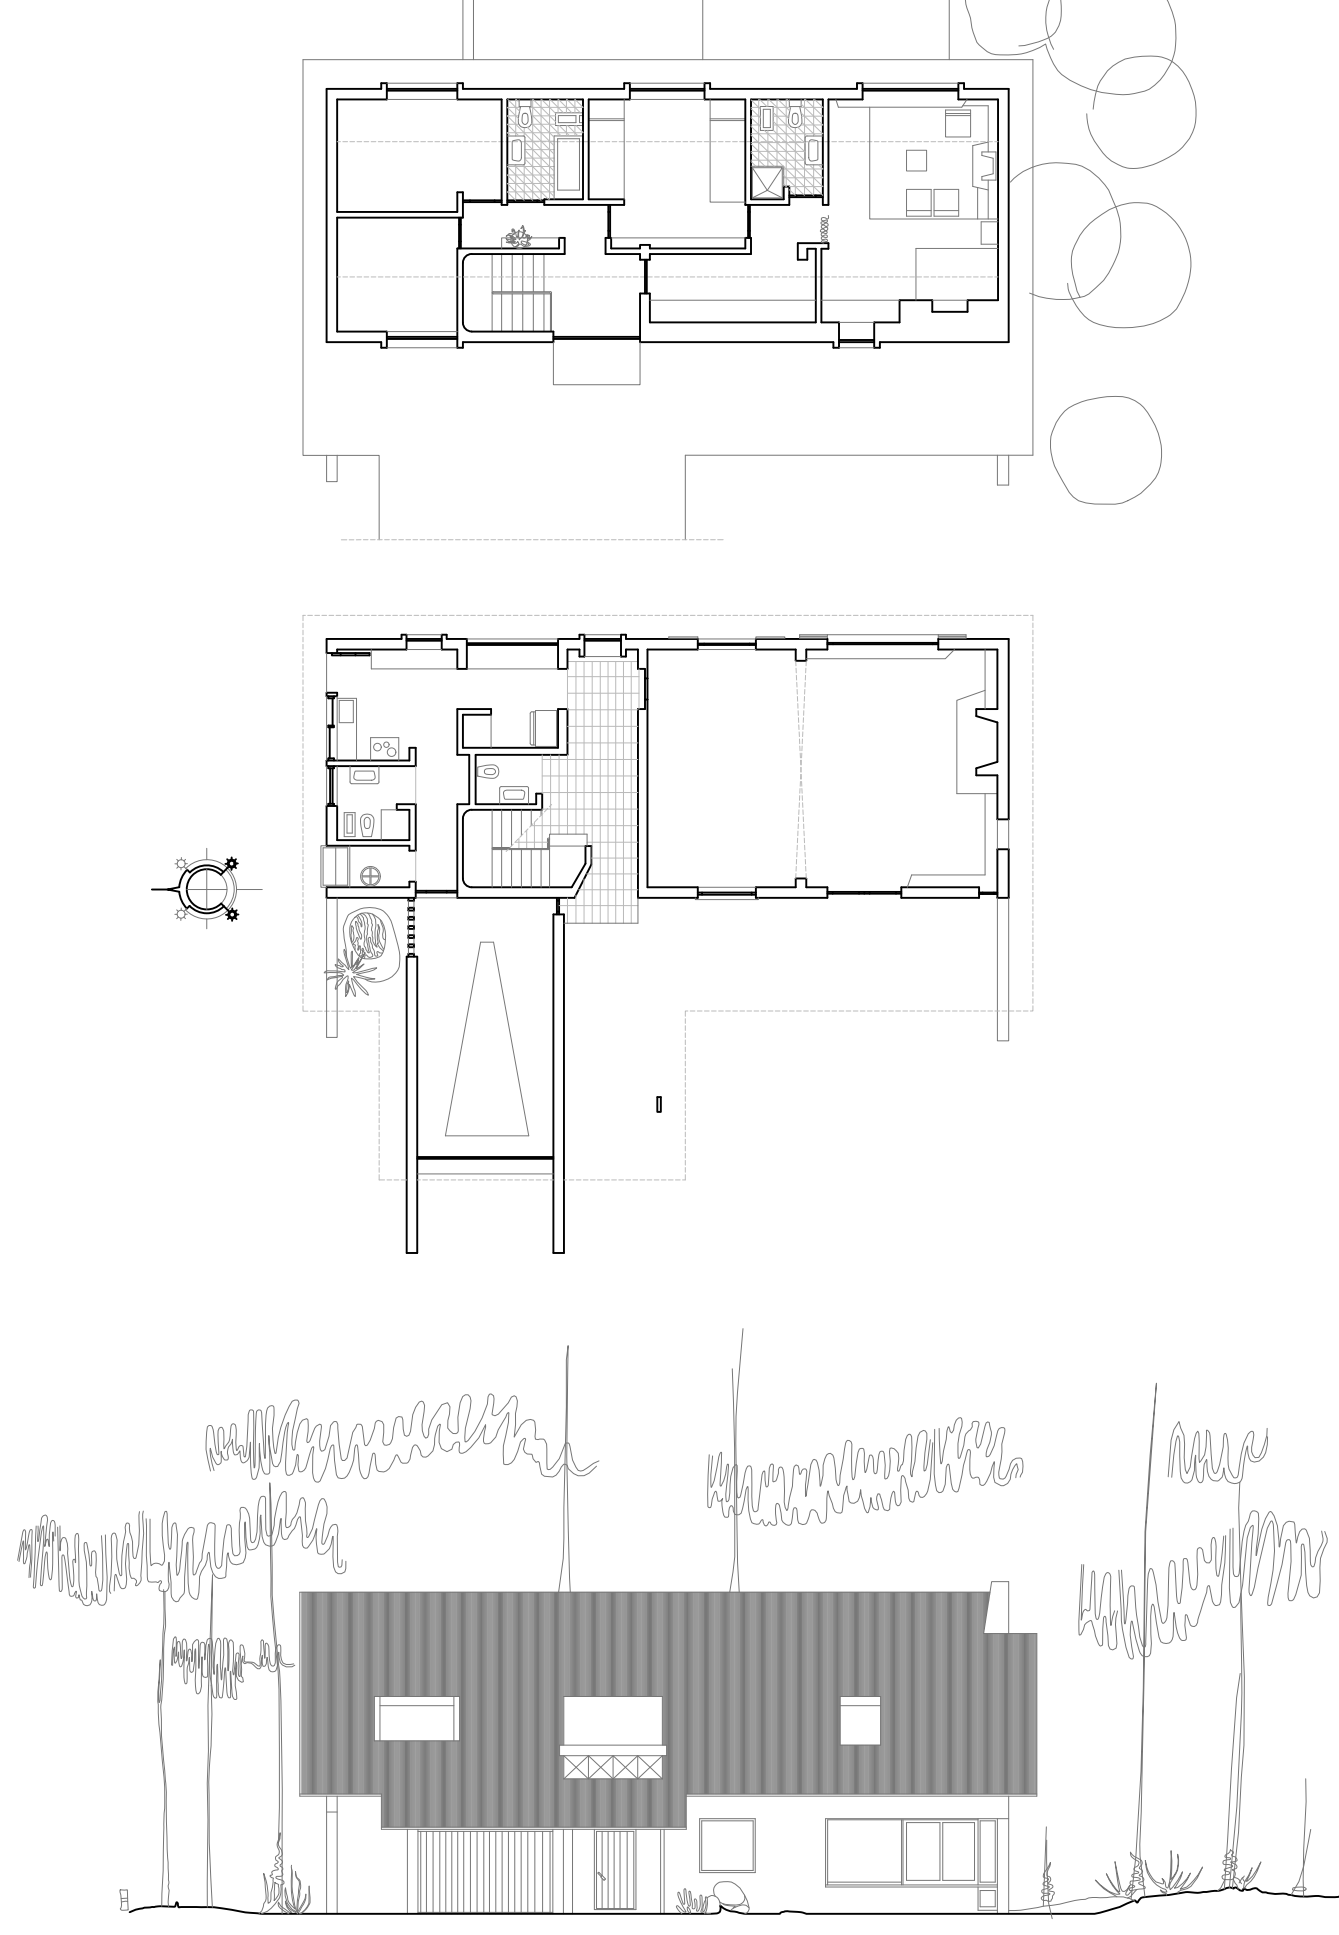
Planta de primeiro piso, planta de rés-do-chão e alçado poente da Casa Emile Henry - escala 1.200.
